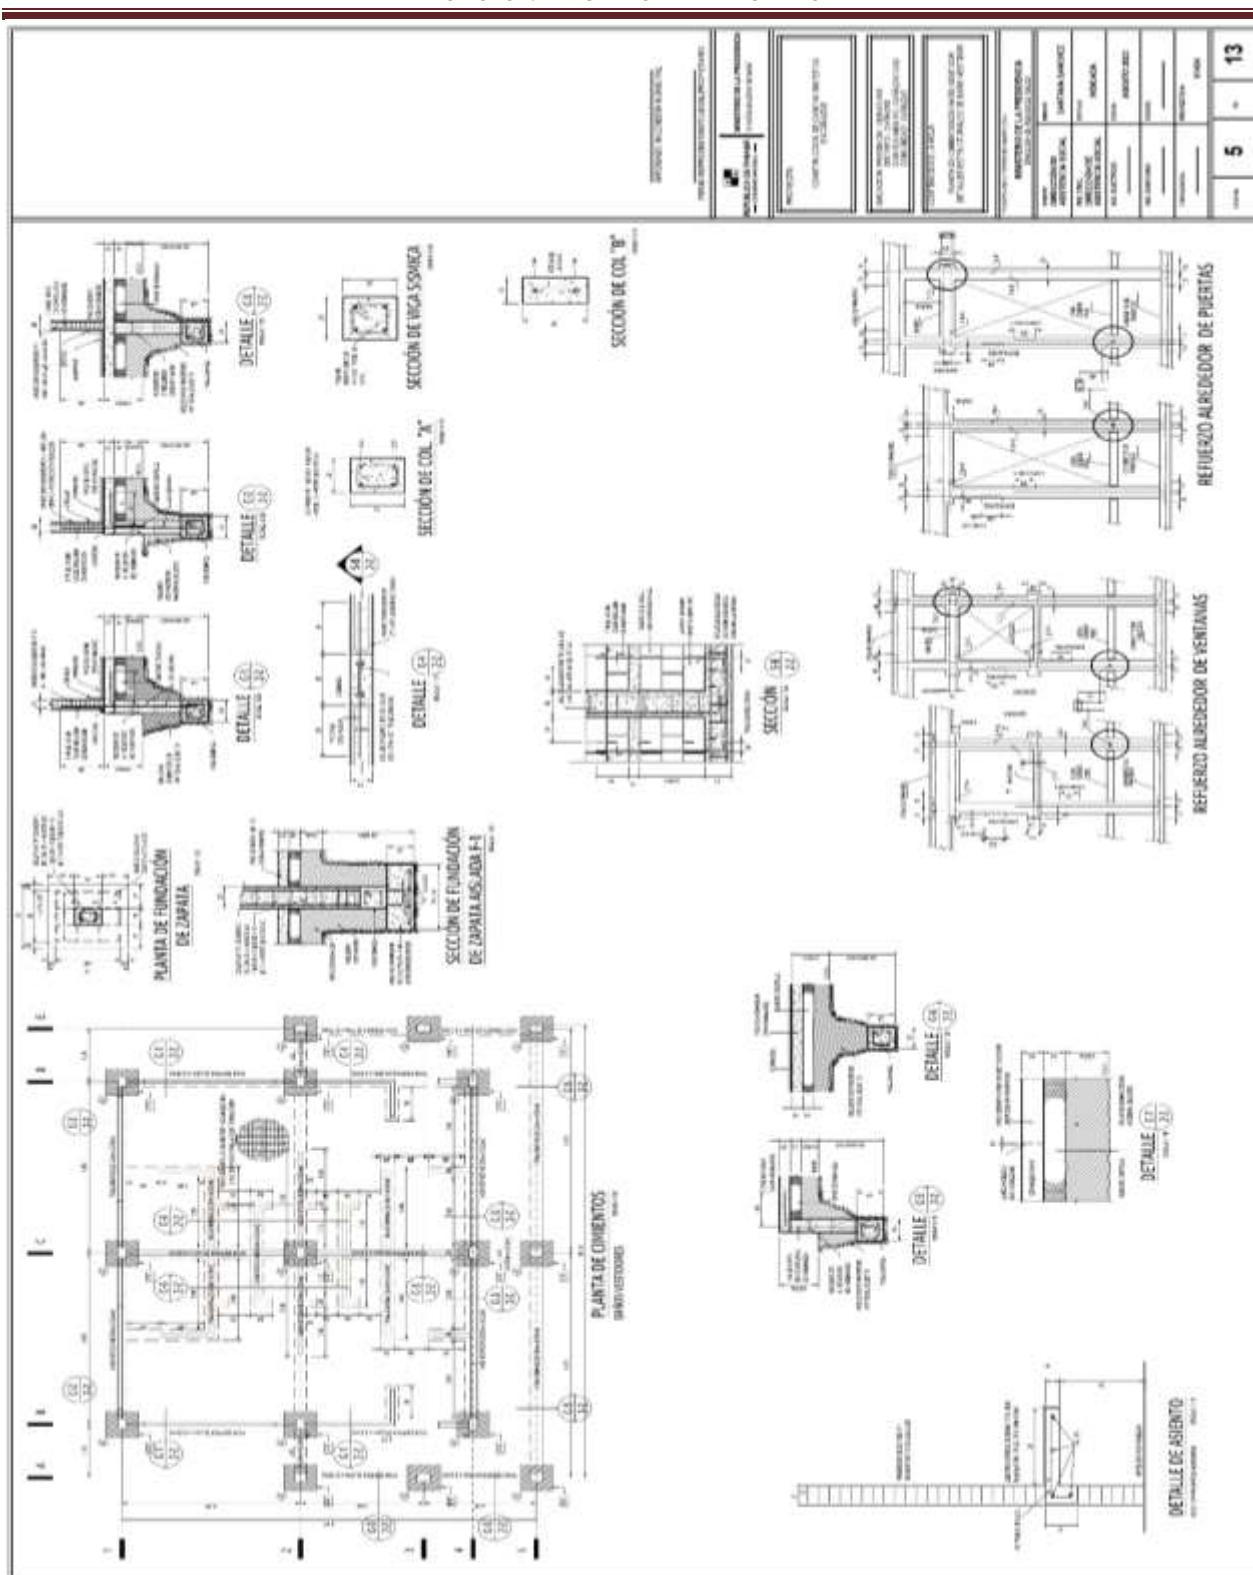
Planta de Cimientos y detalles: baños y vestidores.
